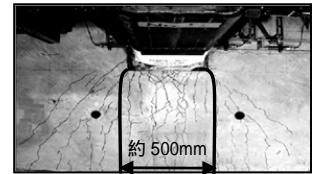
Fp.4 柱前後面近傍ひび割れ状況
